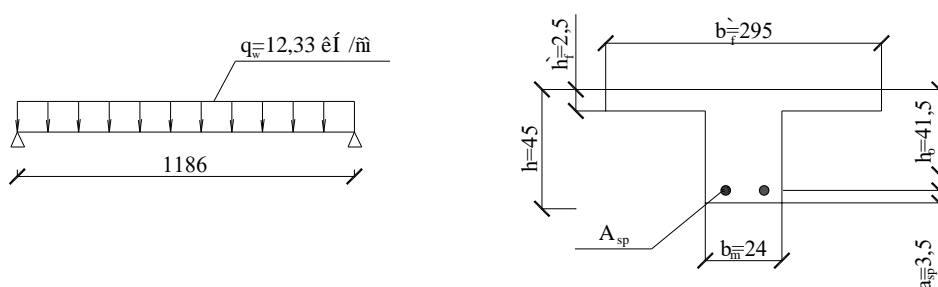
Розрахункова схема та зведений переріз поздовжніх ребер.
